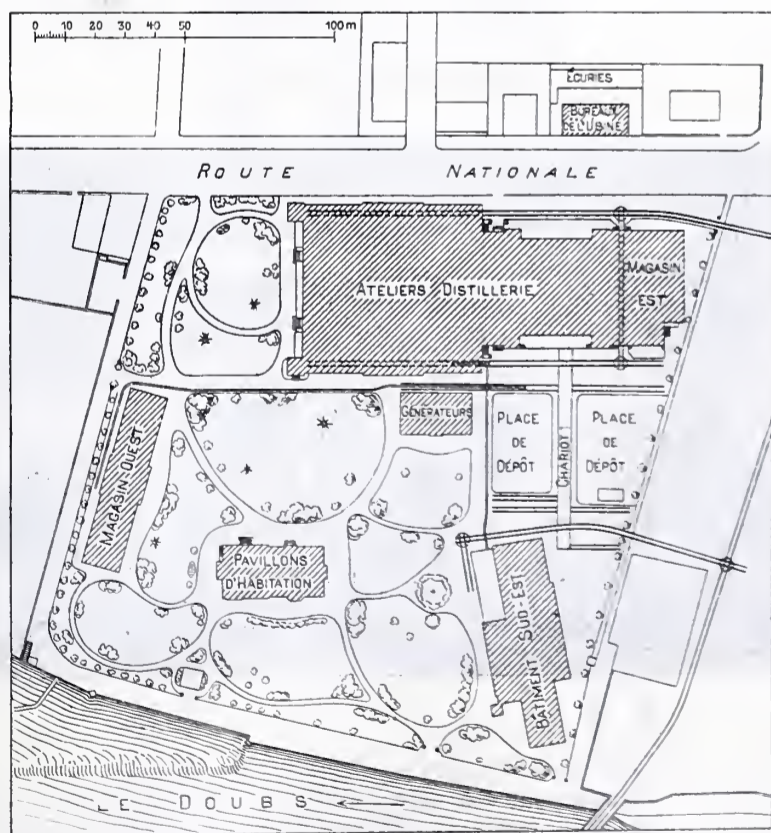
Plan de situation. — Echelle 1 : 3000.
